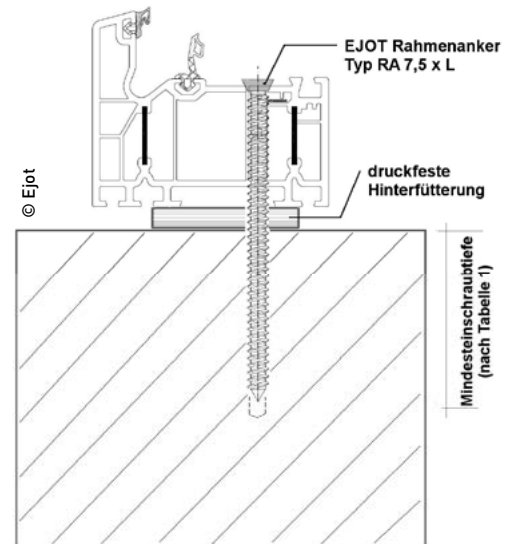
Beispiel einer druckfesten Hinterfütterung.
